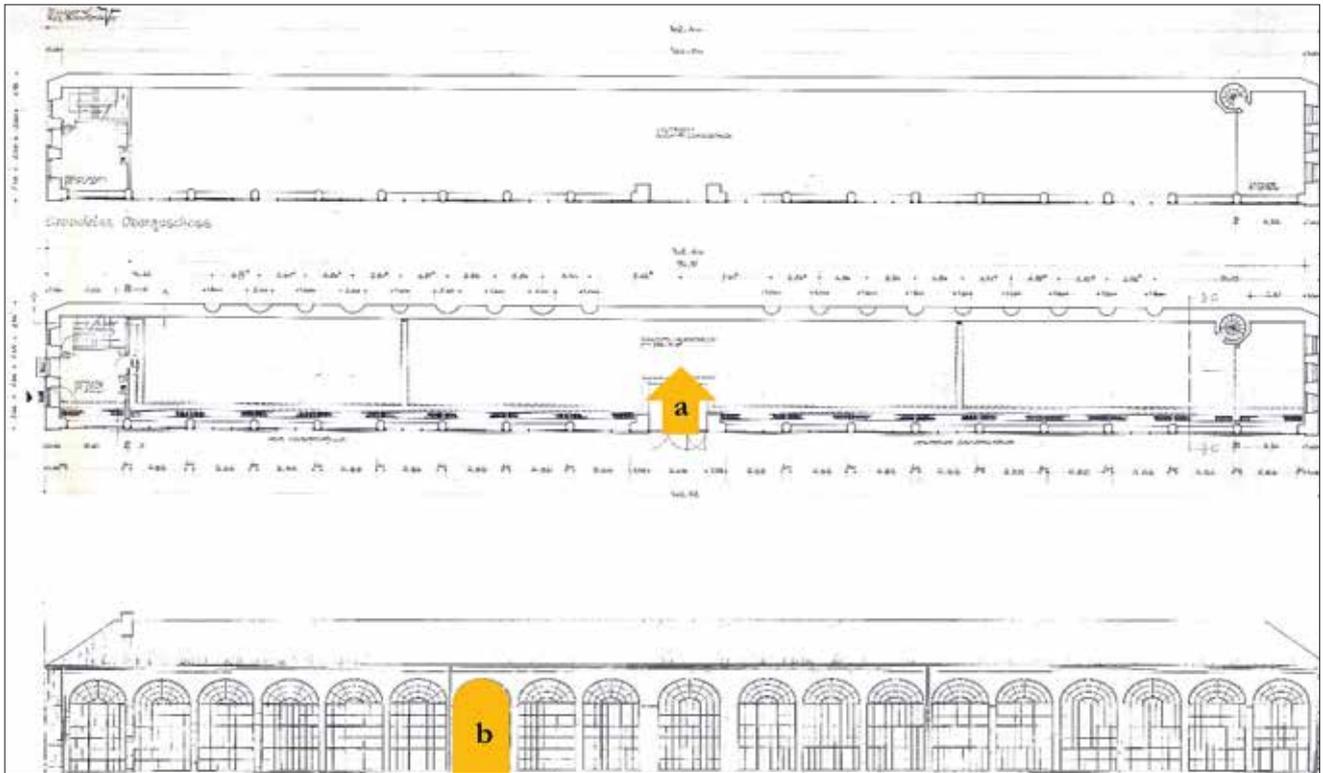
Orangeriegebäude, Planungen zum Wiederaufbau (Planzeichnungen 1966, Mayer Reg. Baudirektor, Landbauamt Würzburg, BSV, Plansammlung Bauabteilung: WÜ-02-04-107 und WÜ-02-04-111)
